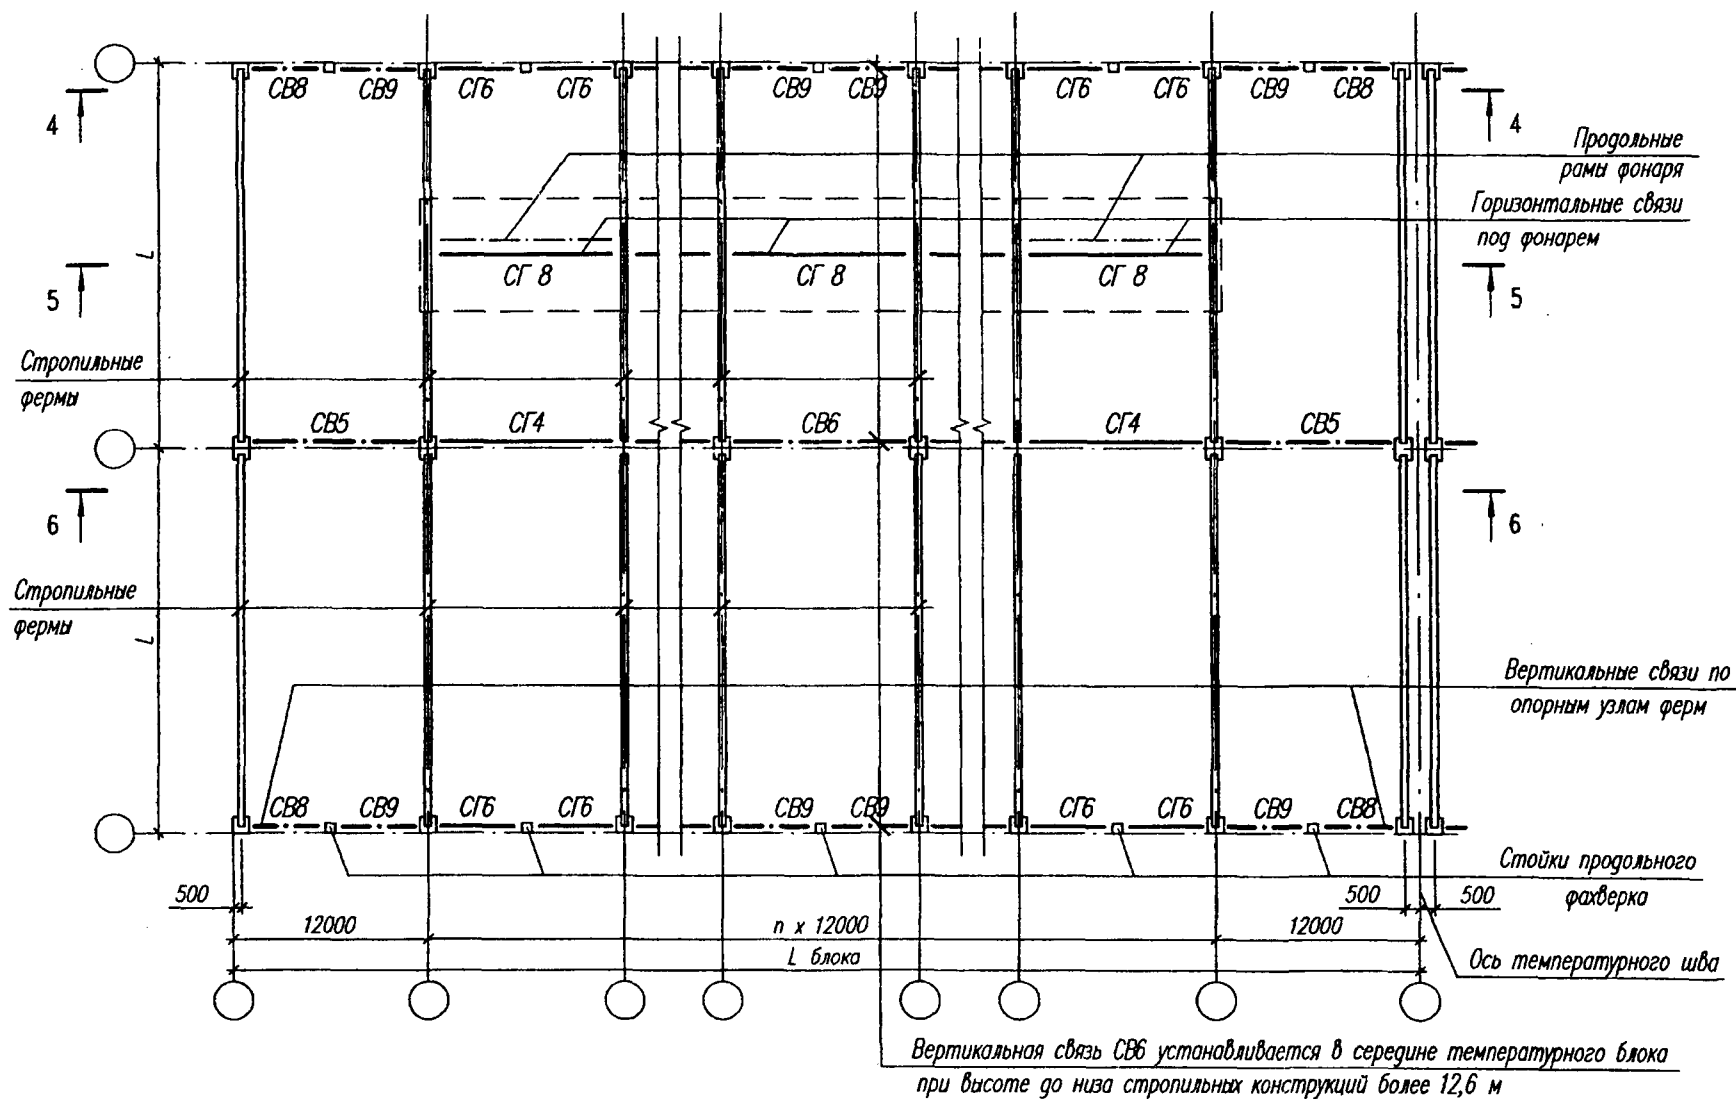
Схема расположения связей в покрытии при шаге ферм 12 м:
